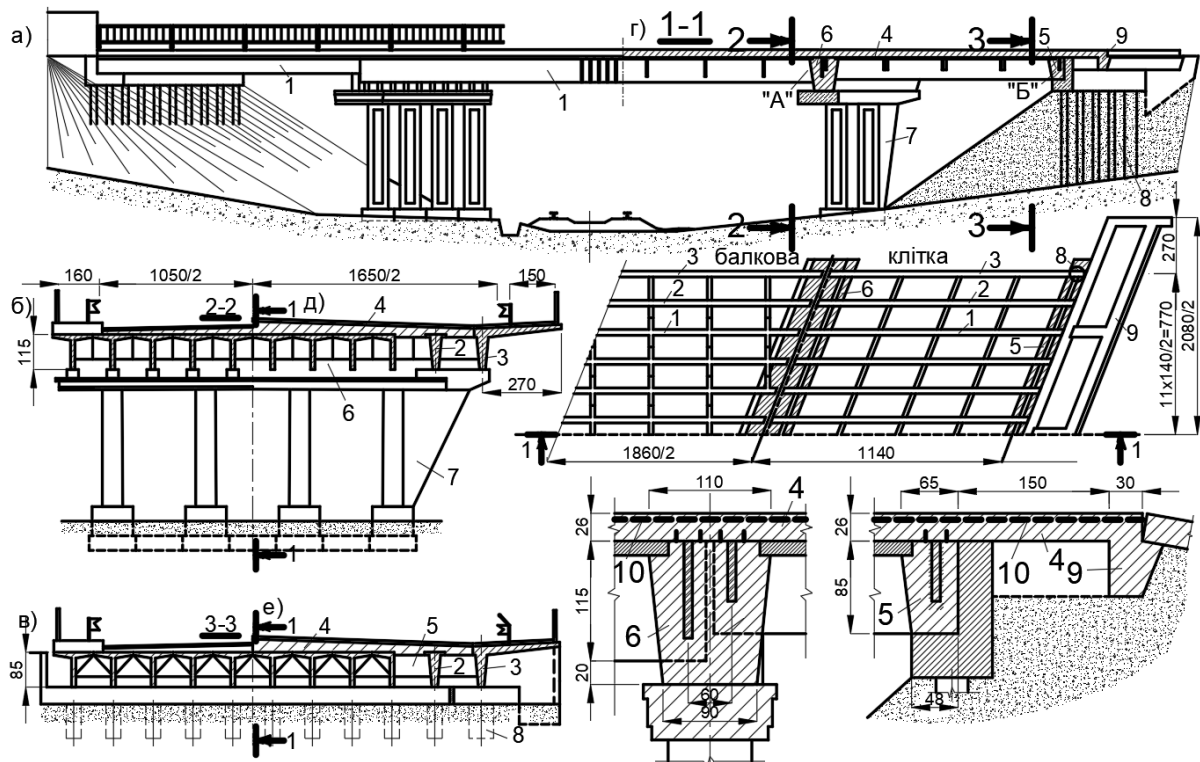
Конструкція існуючого (а, б, в) і реконструйованого (г, д, е) шляхопроводу:
